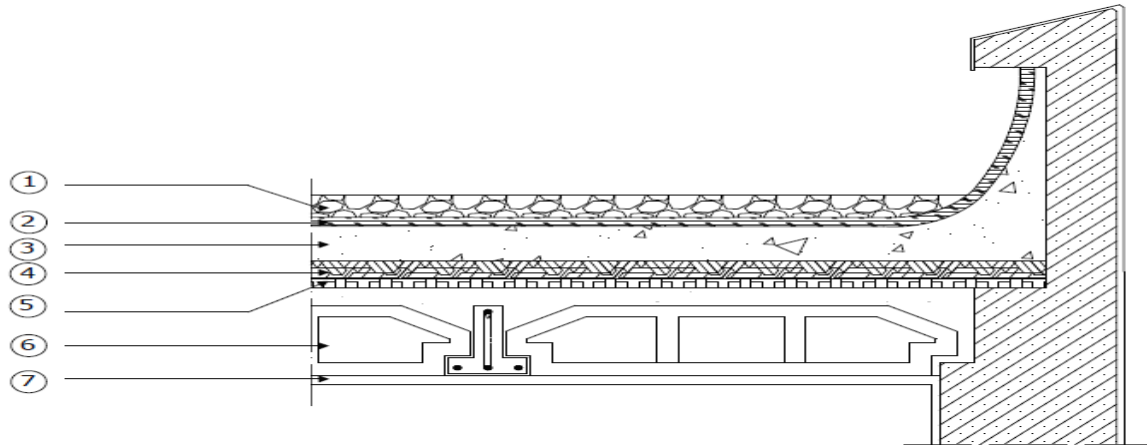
Coupe verticale du plancher terrasse inaccessible.
